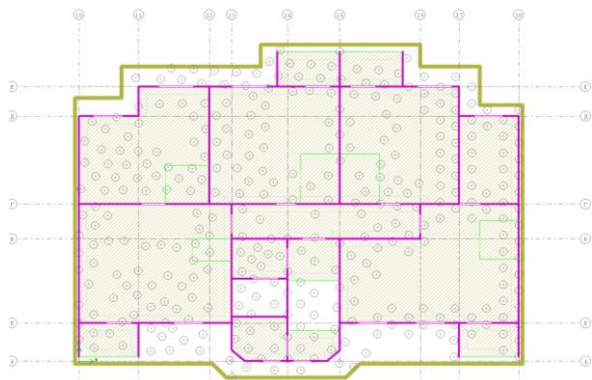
План фундамента центральной части здания (с учетом добивки новых свай)
